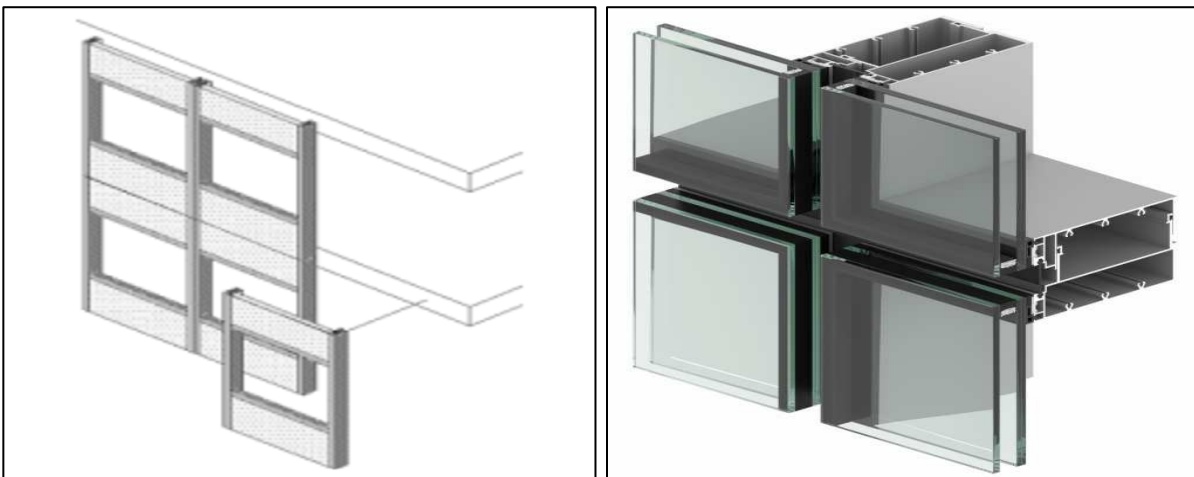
Sistema de muro cortina. Fuente: Riventi fachadas estructurales.
